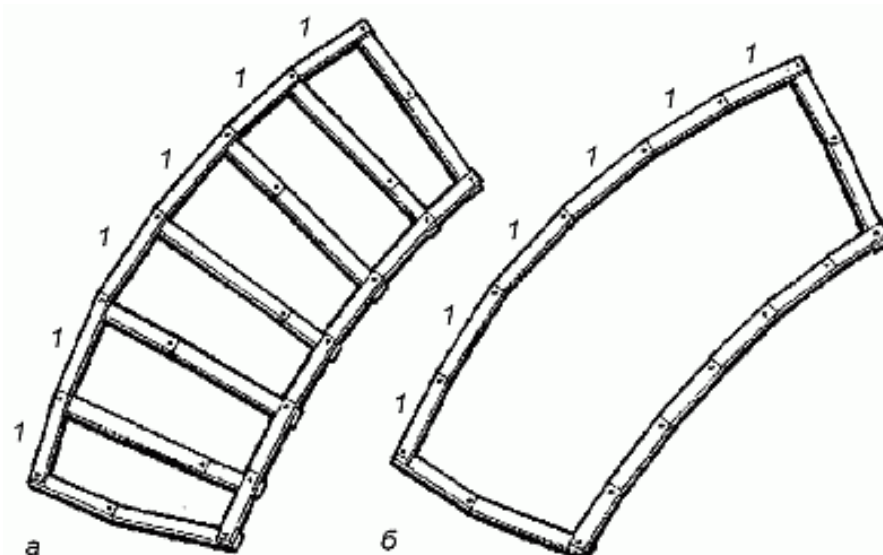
Схема сборки контуров арочного каркаса: а – верхний контур; б – нижний контур
